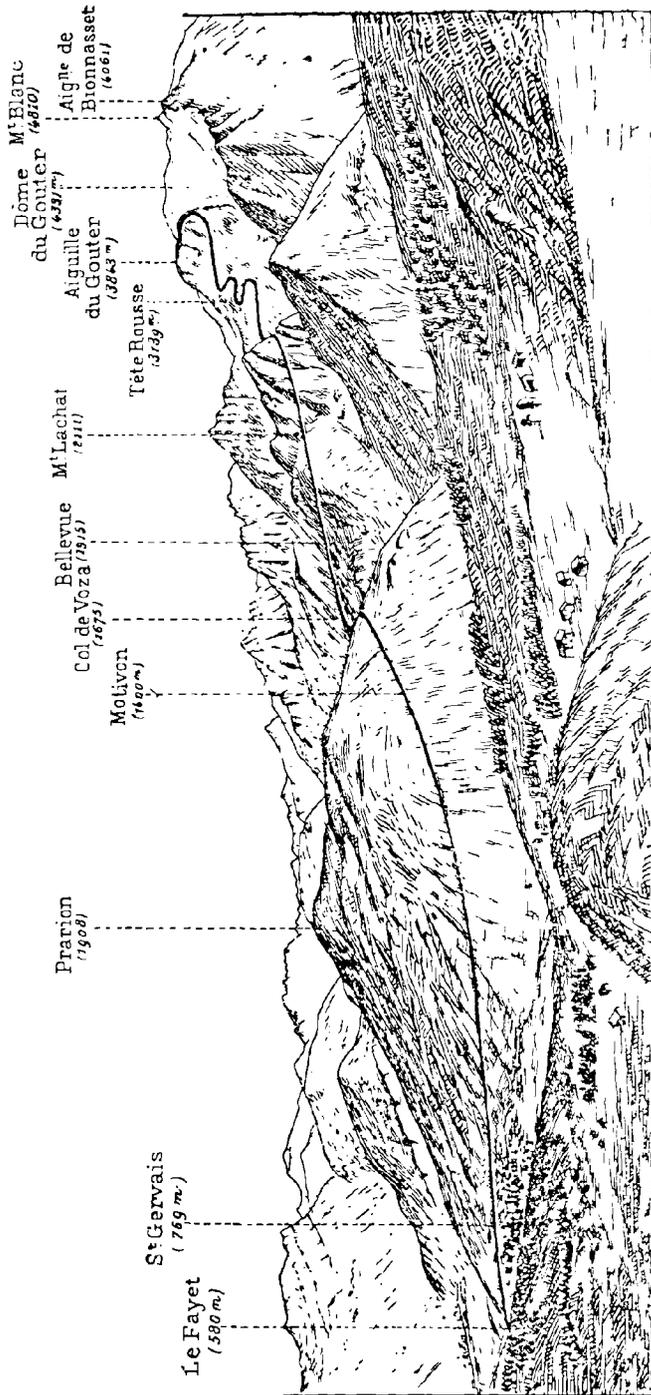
Vue d'ensemble du tramway du Mont Blanc.
